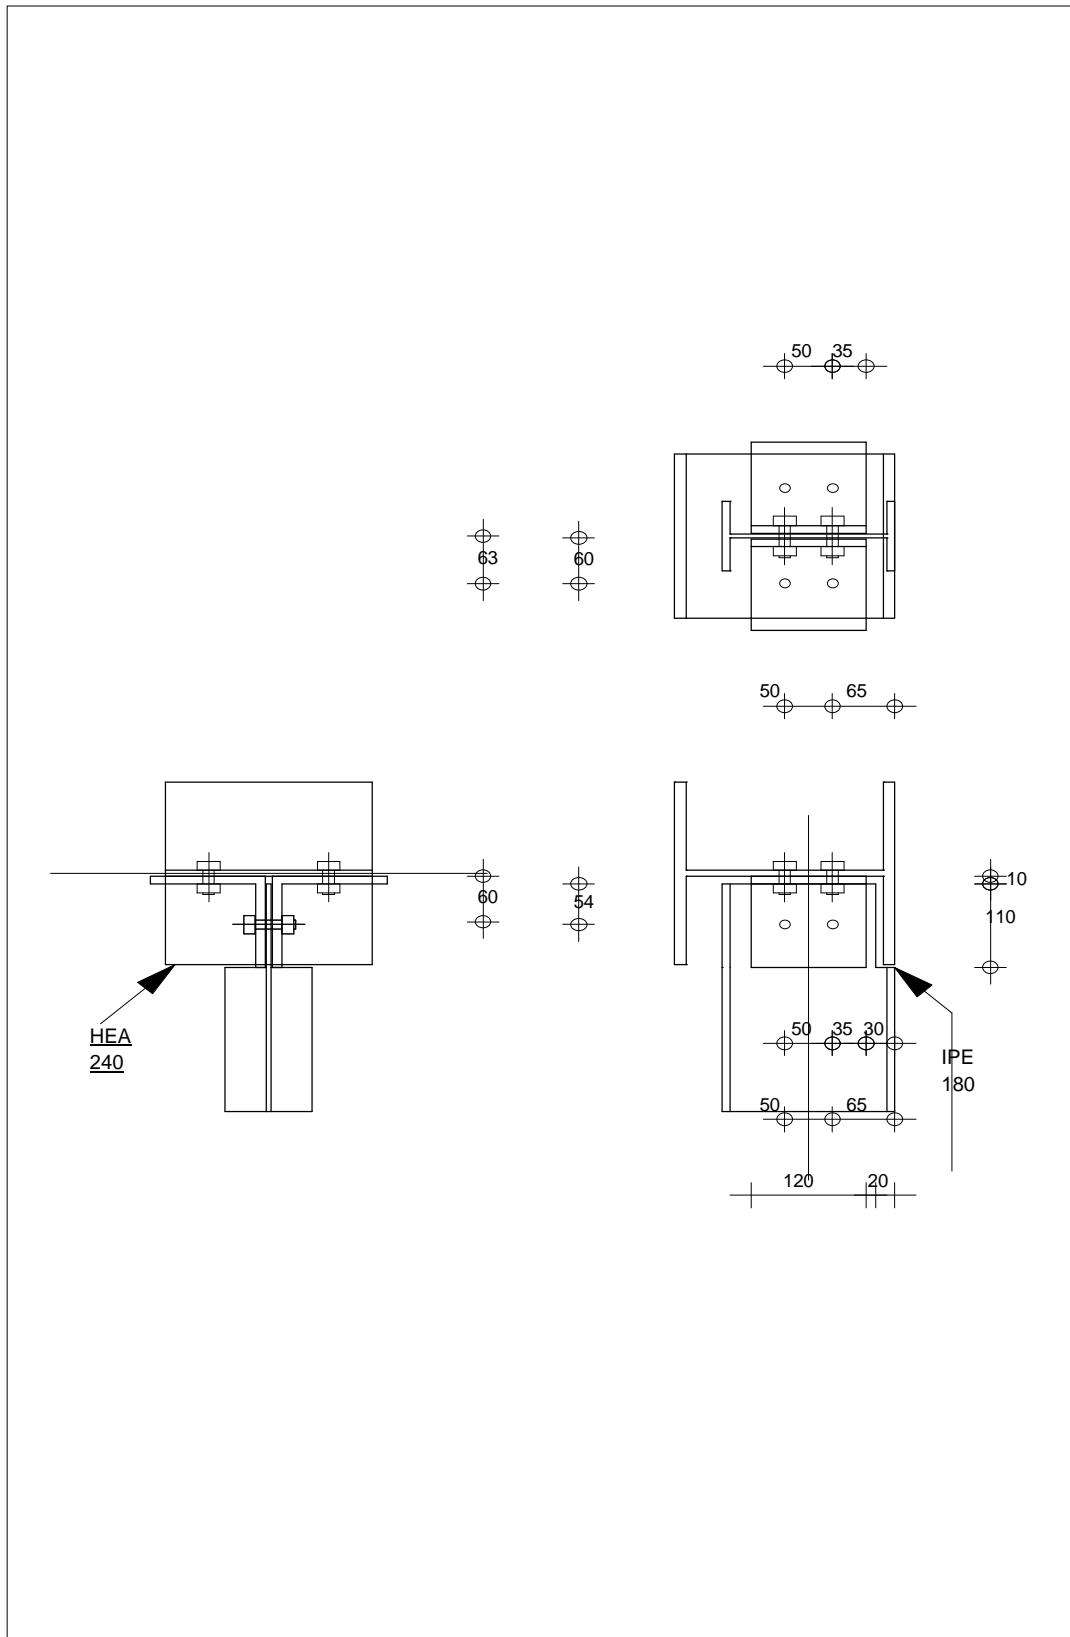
Schéma D'assemblage solive-poutre principale.
